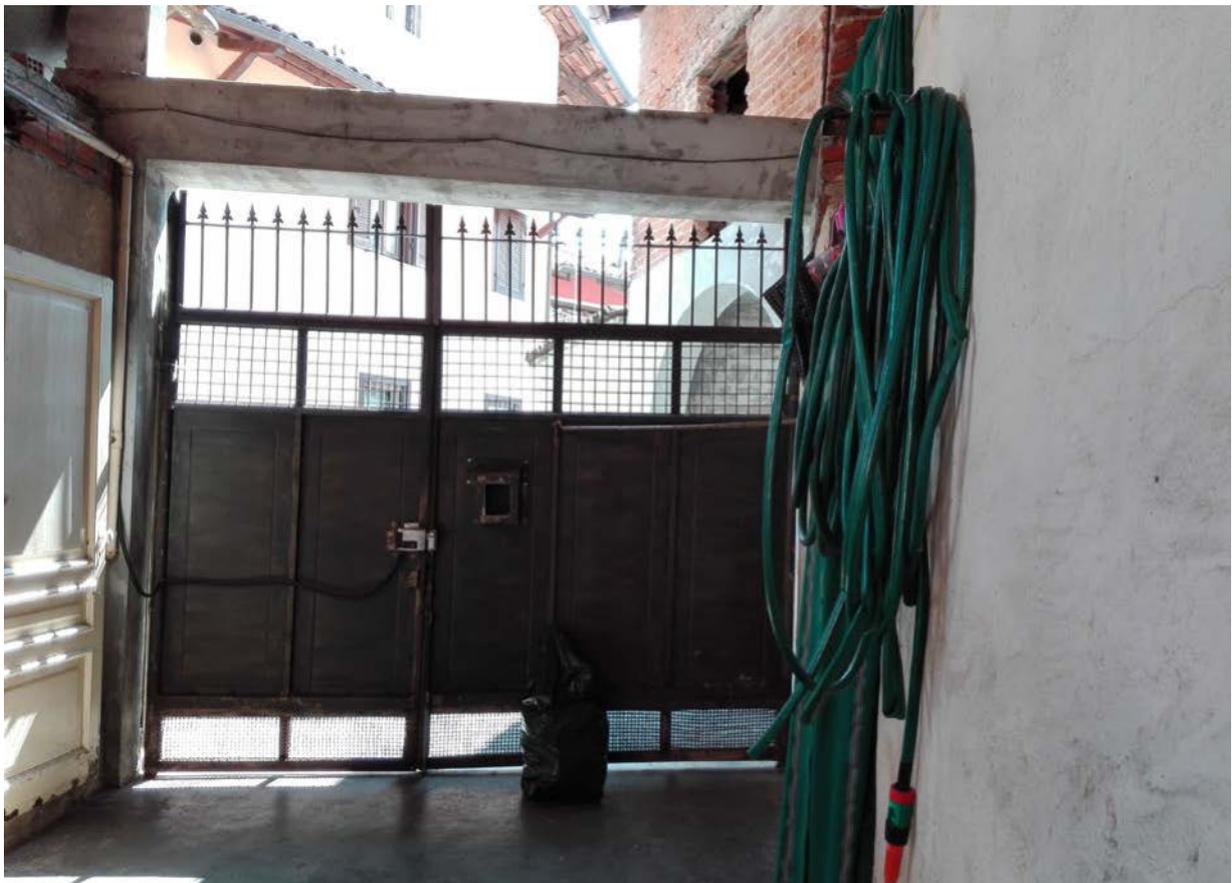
Vista del cancello di ingresso dal cortile
